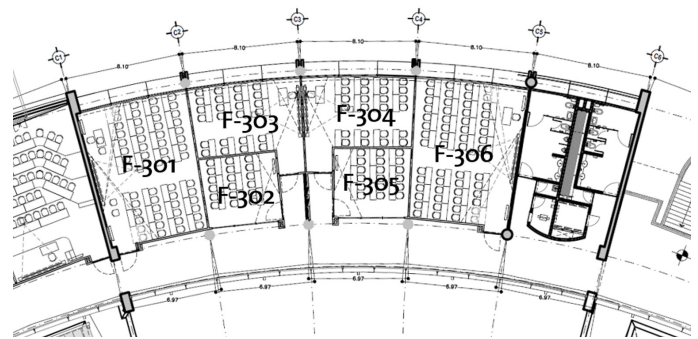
Planta arquitectónica del tercer nivel del edificio F.
